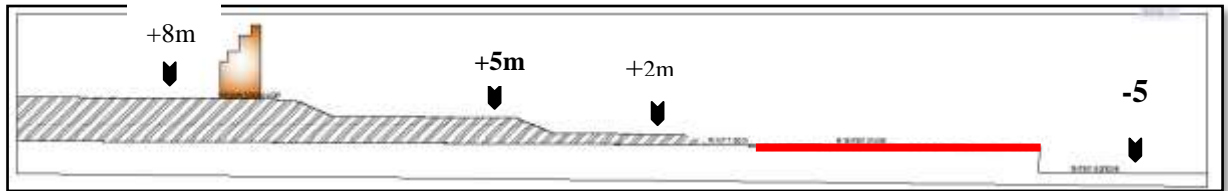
Coupe de terrain par rapport au minaret de Mansourah..
